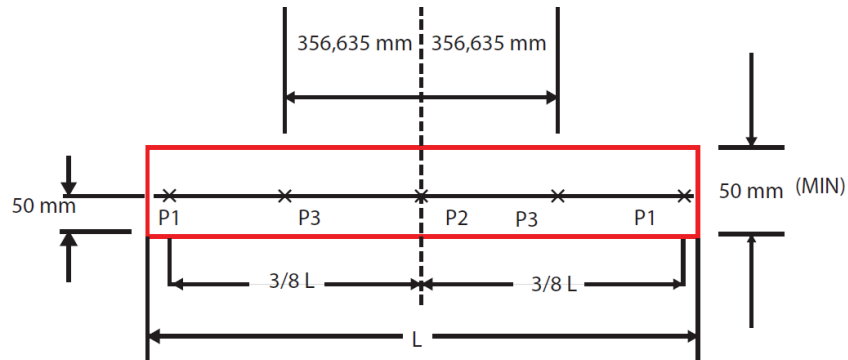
Dispositivo antiempotramiento con detalles de los puntos de prueba y geometría según la normativa canadiense. Vista trasera.
